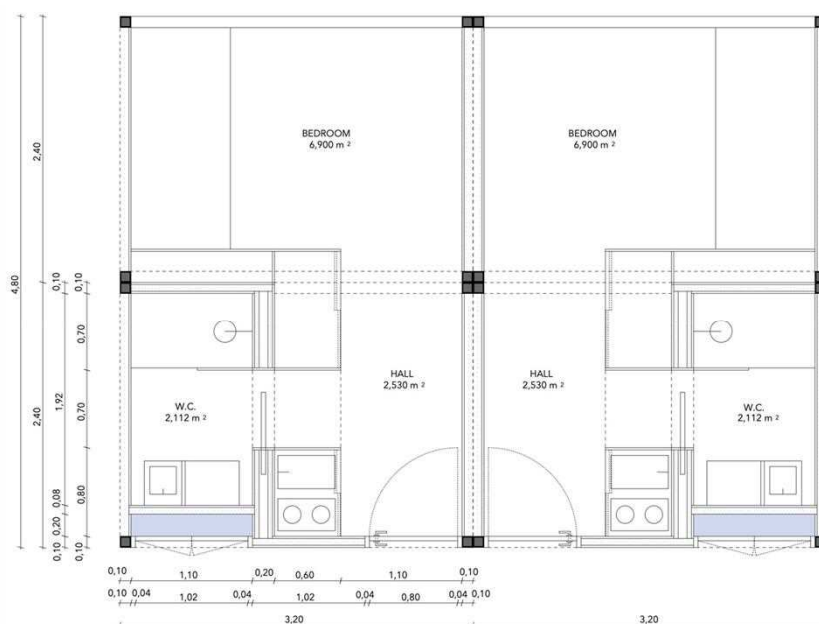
Planta dos apartamentos (dimensões e pormenores dos módulos).
